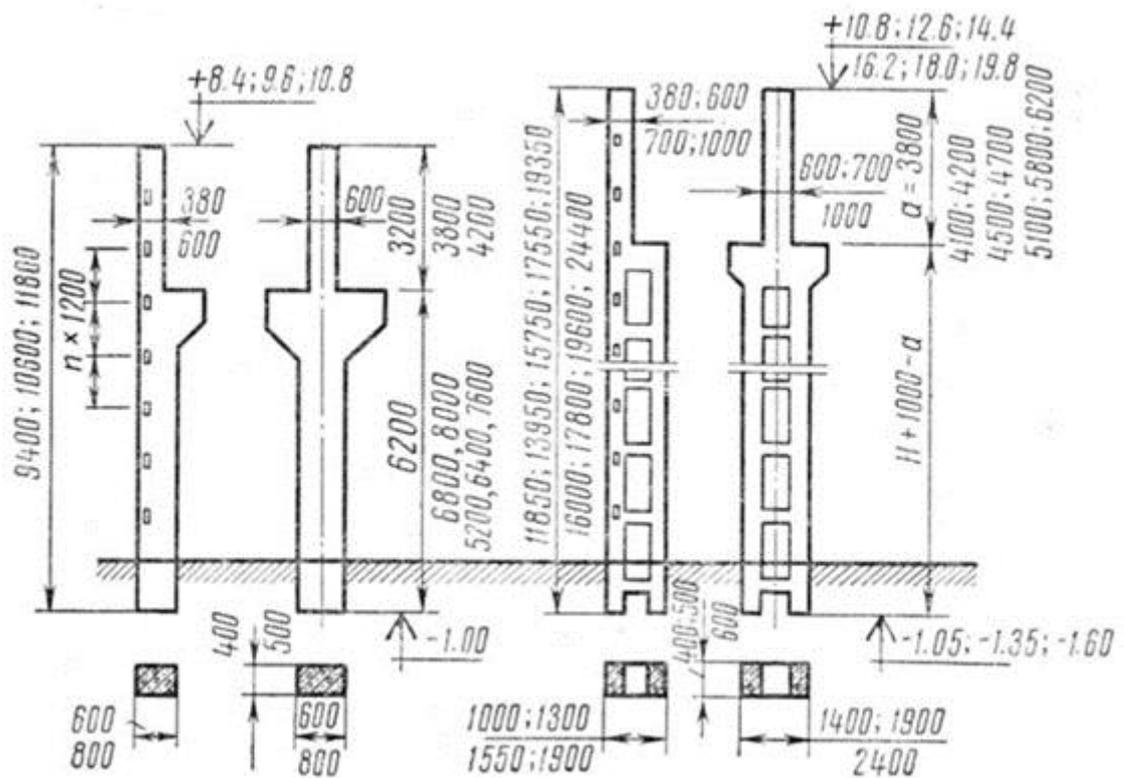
Залізобетонні колони для будівель з мостовими кранами
